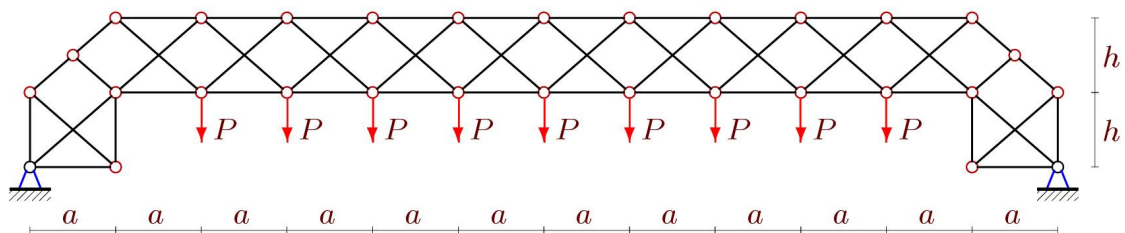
Ферма, нагрузка по узлам нижнего пояса, $n = 5$
